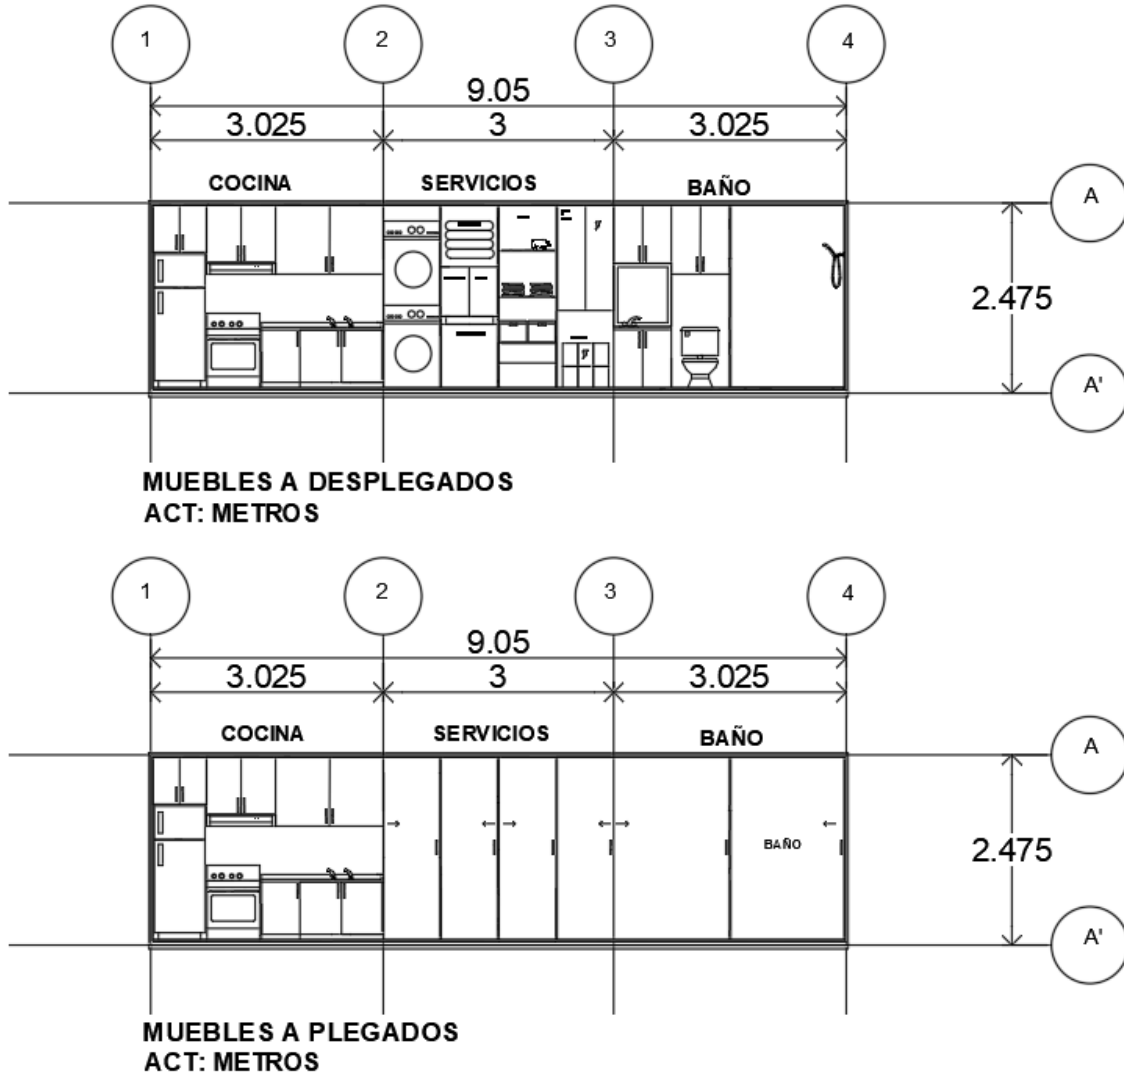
Alzado A muebles (Elaboración propia, 2023)
